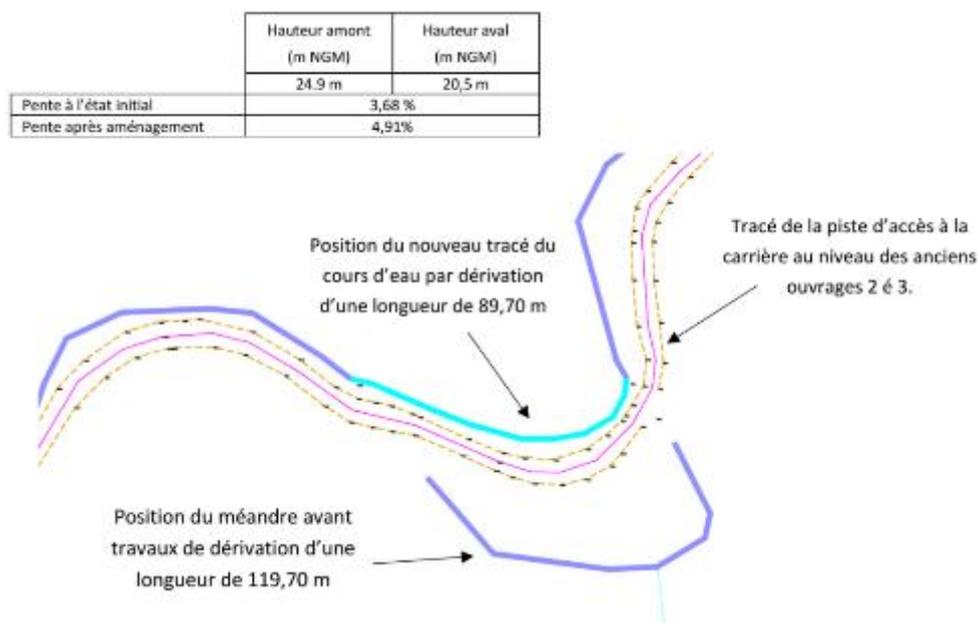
Pentes, longueurs, plan de l'ancien méandre (ex ouvrages n°2 & 3) et plan de la dérivation créée.
